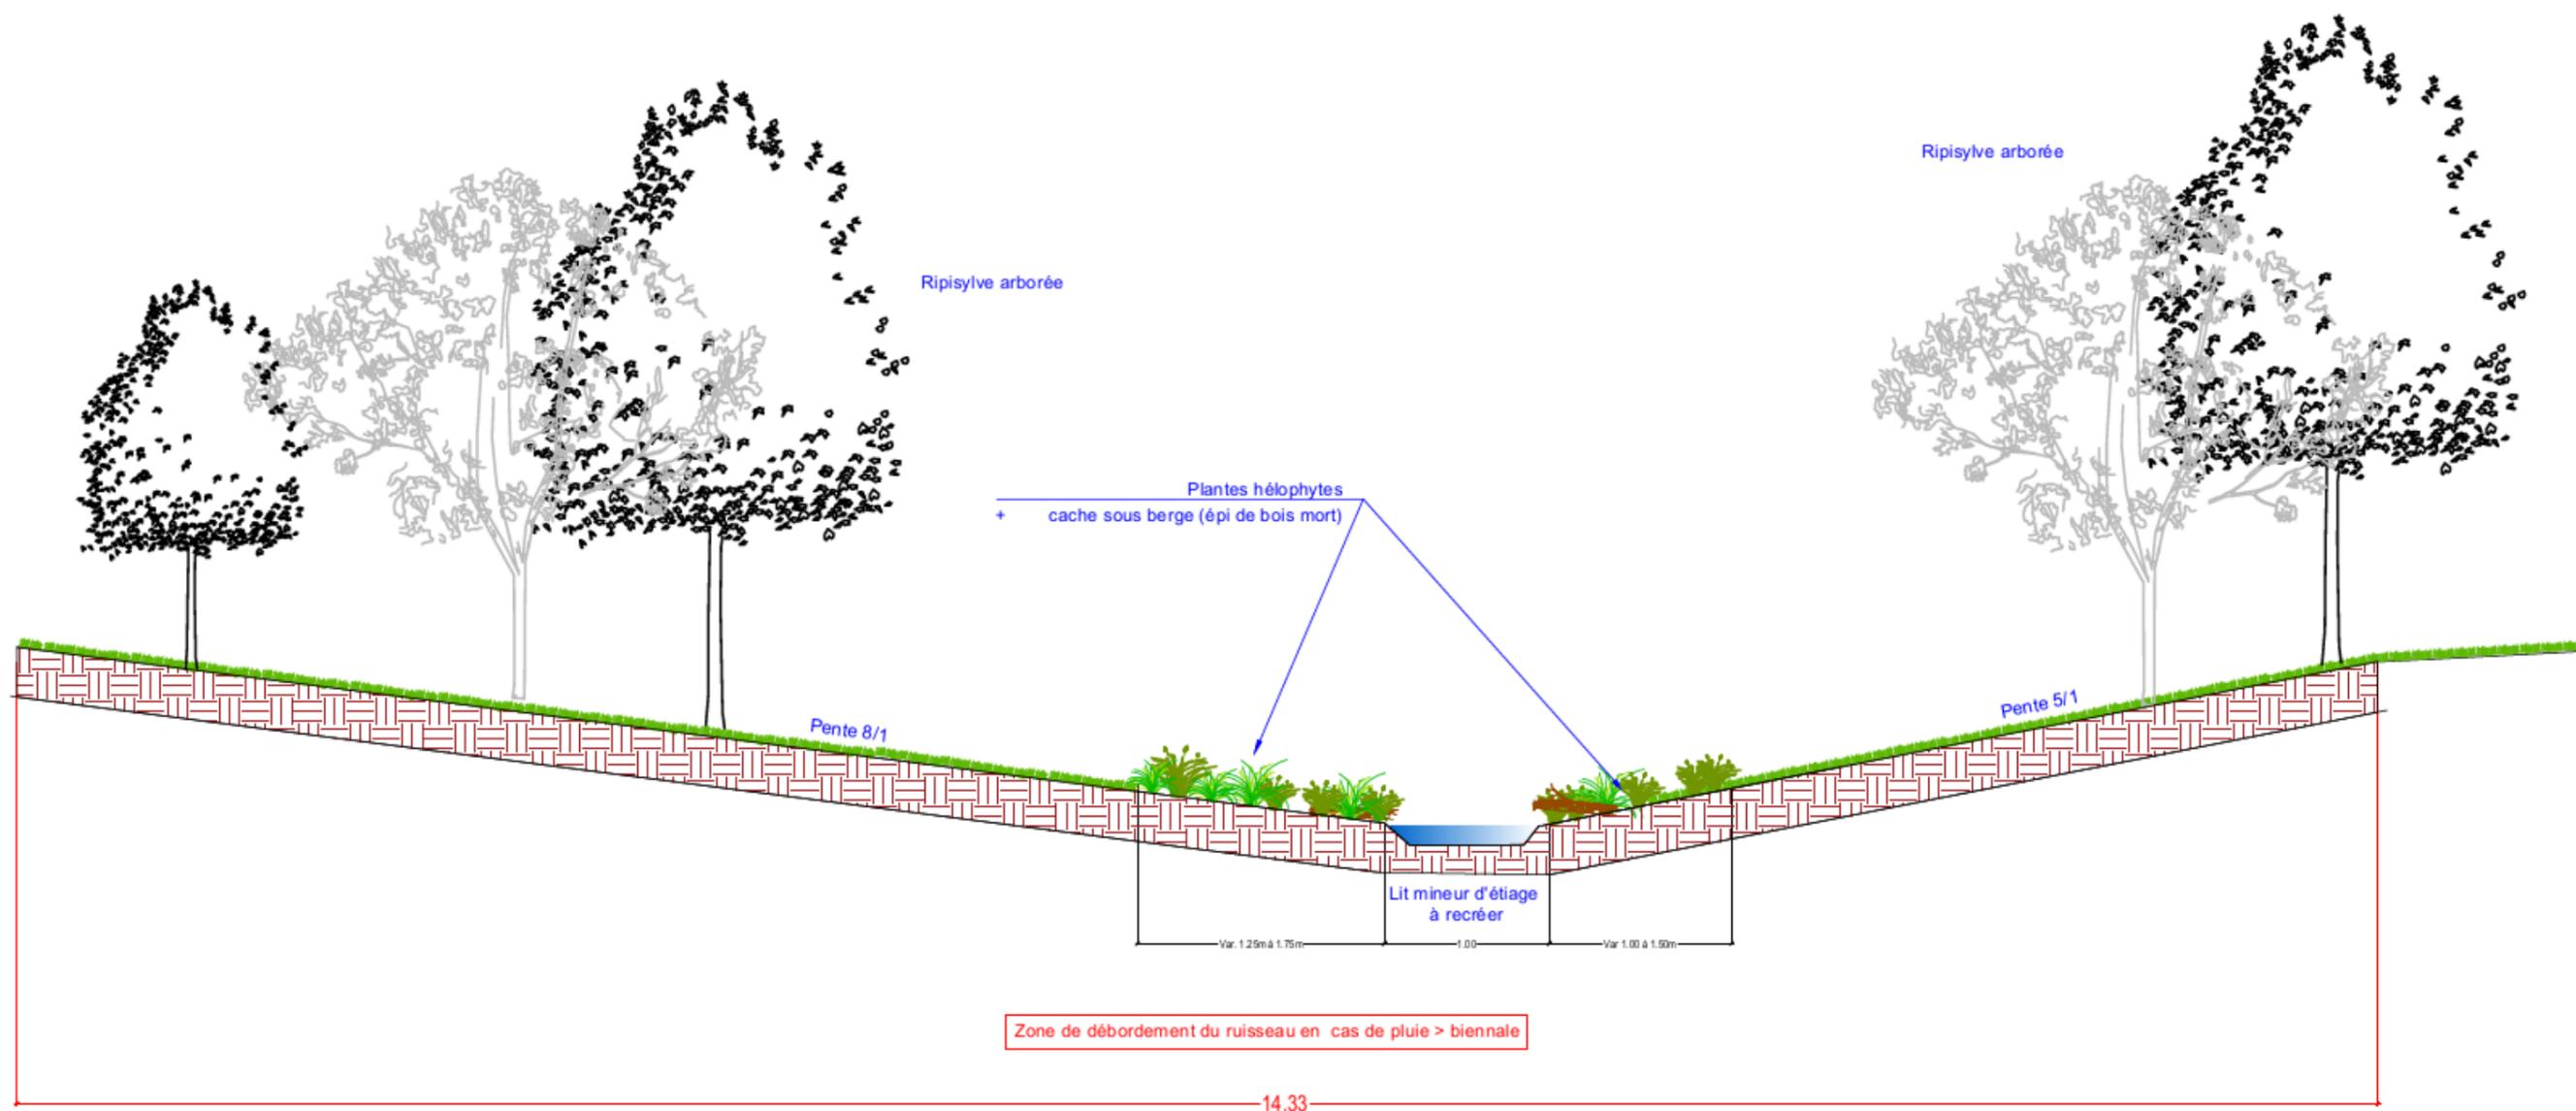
REMEANDRAGE DU RUISSEAU PREVU DANS LE CADRE DU PROJET – COUPE BB'
